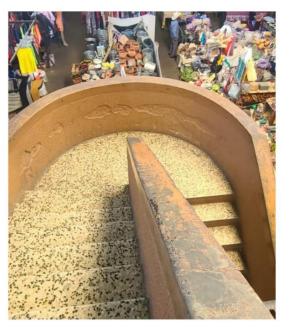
Fotografía de gradas Fuente: imagen propia Circulación vertical, obstaculiza el ingreso principal. Donde se pierde la apreciación de la plaza central
